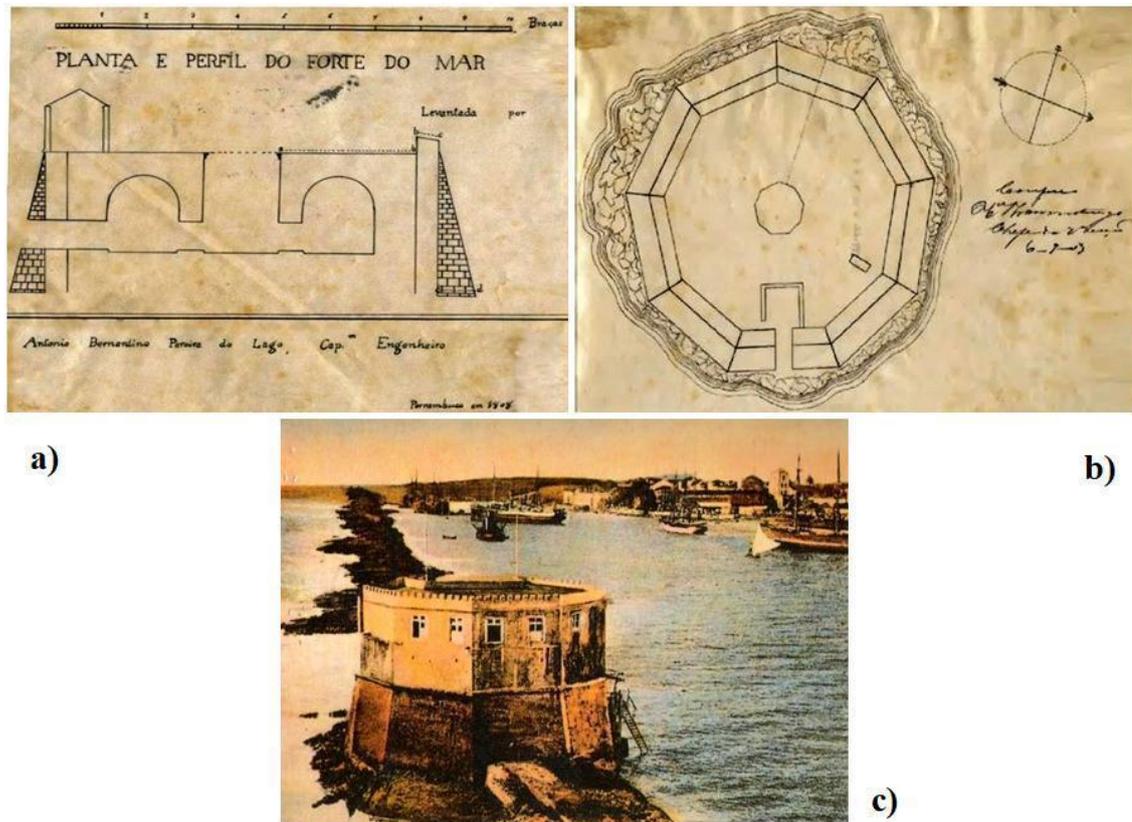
(a) Plantas do projeto de reconstrução de 1808; corte transversal do forte. (b) Plantas do projeto de reconstrução de 1808; vista superior. e (c) imagem do Forte de São Francisco da Laje em 1905. (Fonte: Costa, 2021).
